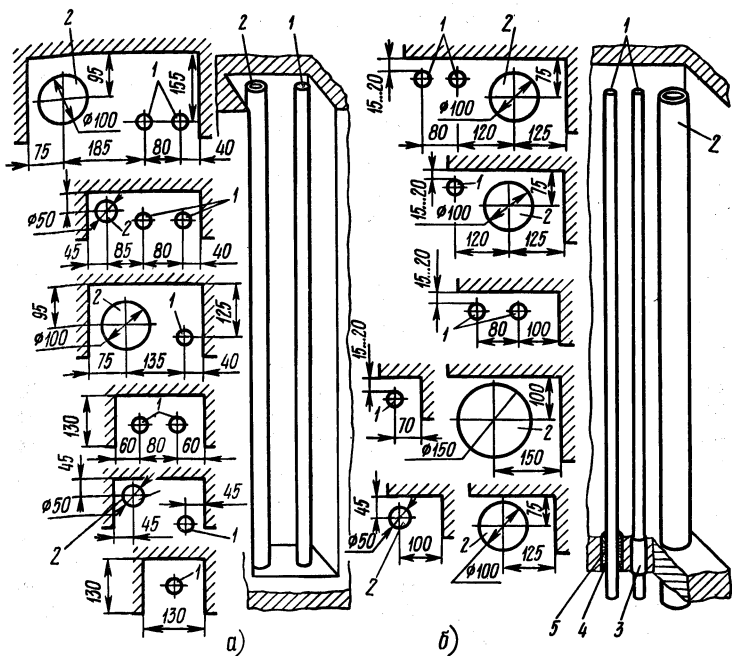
Монтажное положение стояков при скрытой (а) и открытой (б) прокладках:
